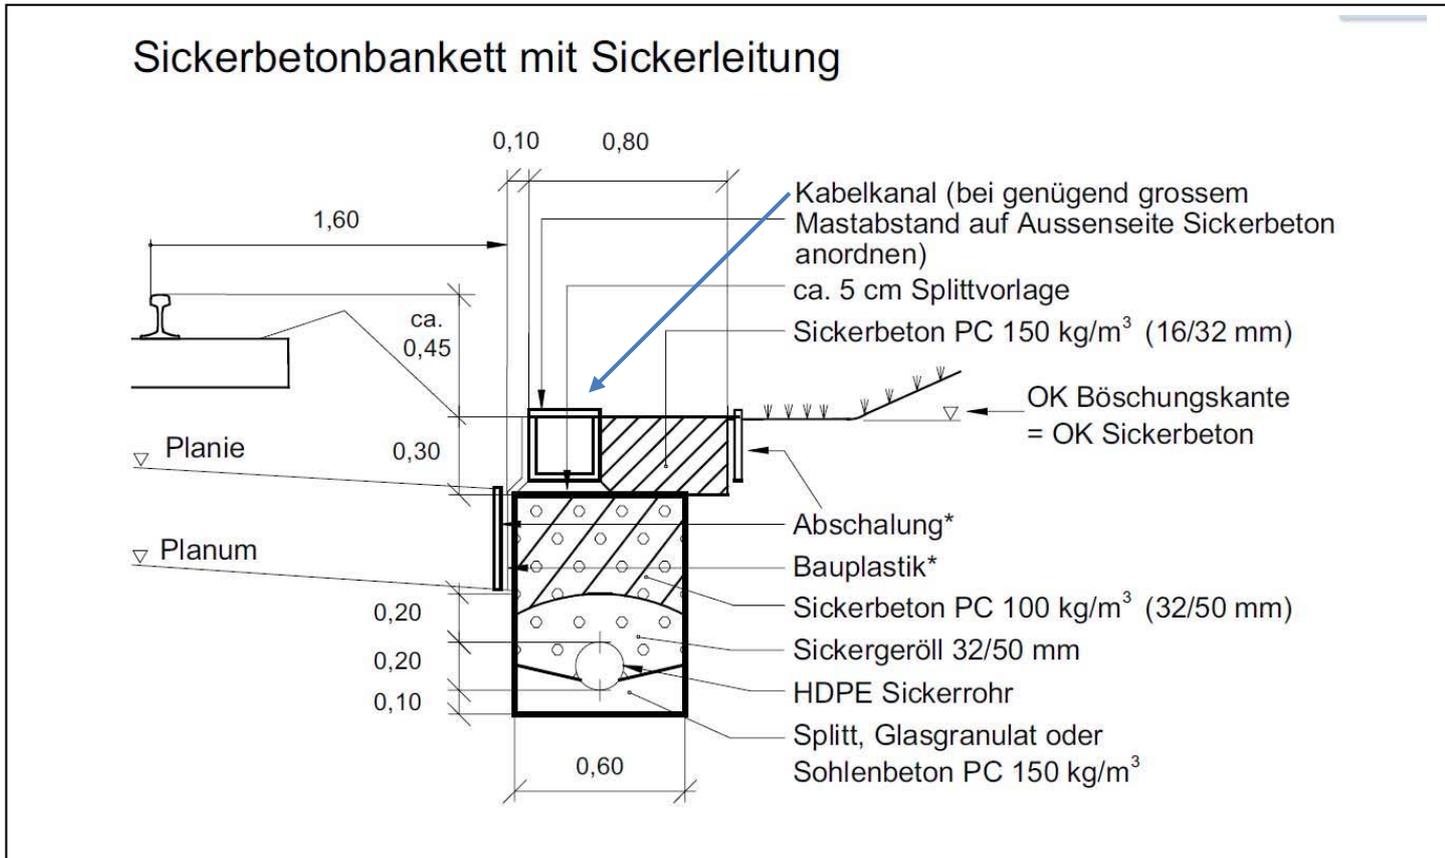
stellt den Ausschnitt Sickerbetonbankett mit Sickerleitung dar; gut sichtbar darauf auch der Kabelkanal.
